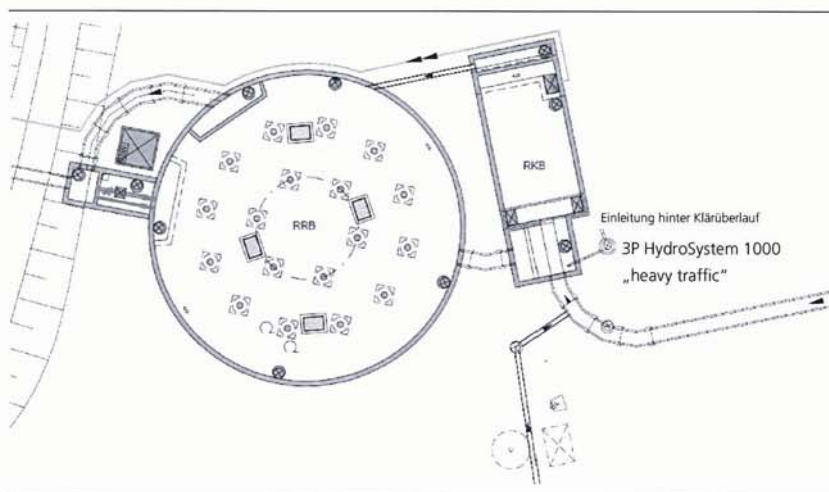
Lageplan der Versuchsanlage „Kulloch“
